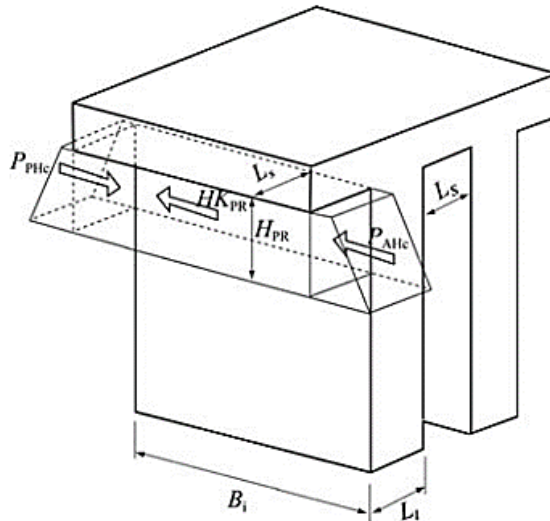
Kolon gruplarının kesit alanı boyutları
